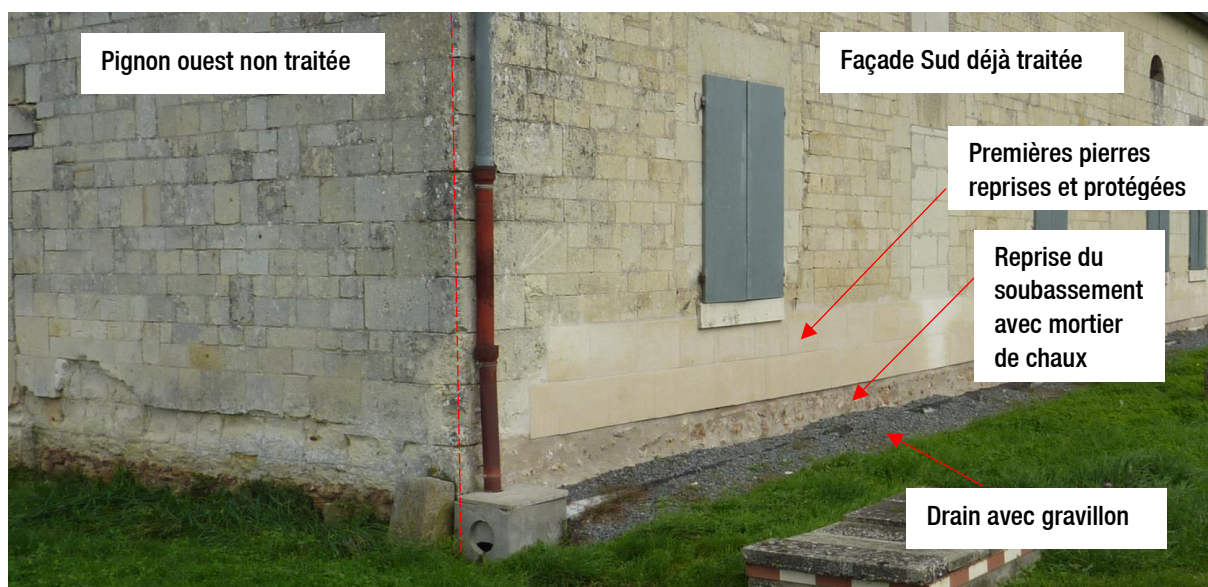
Illustration des travaux déjà réalisés sur la façade Sud à réaliser sur les façades Nord et Ouest
